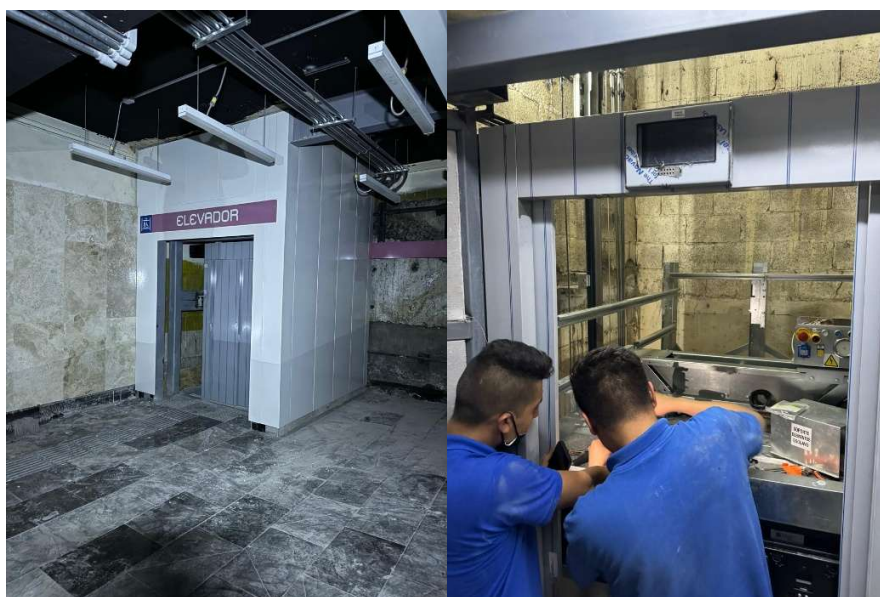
Detallado de elevador previo a su entrega. Elaborado por el autor.
